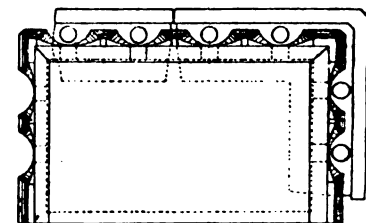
Grundriss einer Kachelschicht mit Feuerzugplatte.
